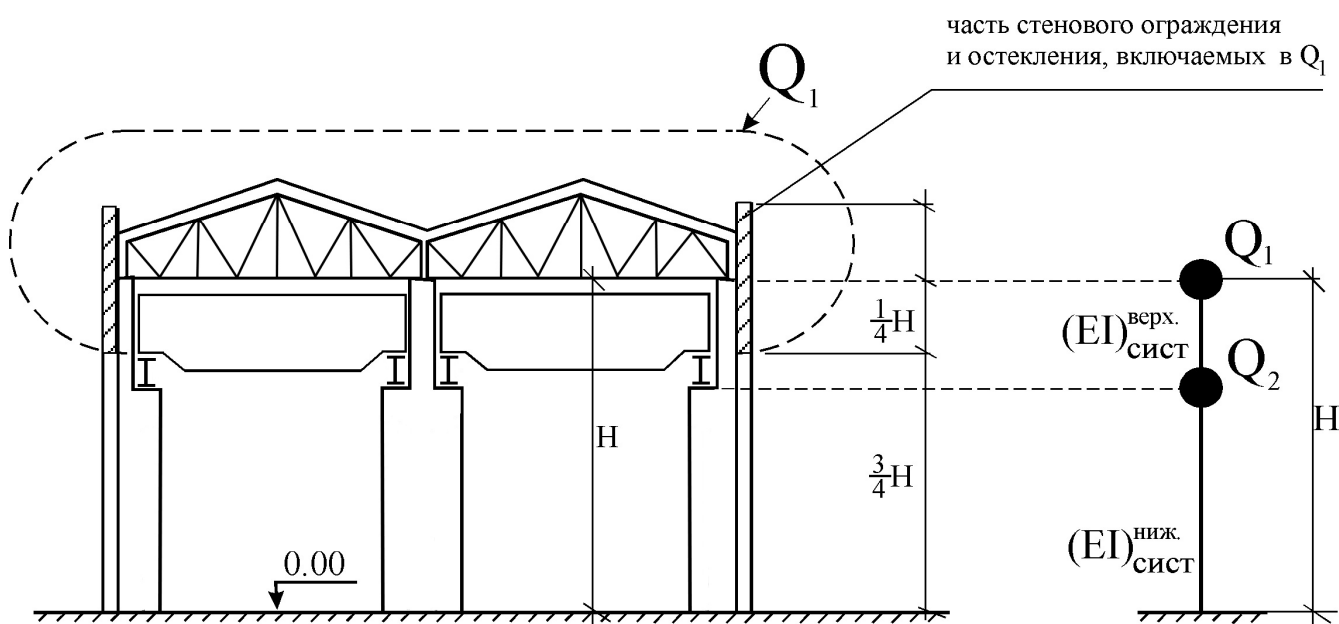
Формирование динамической расчетной схемы для производственного здания с мостовыми кранами (вариант с шарнирным соединением балок с колоннами)
